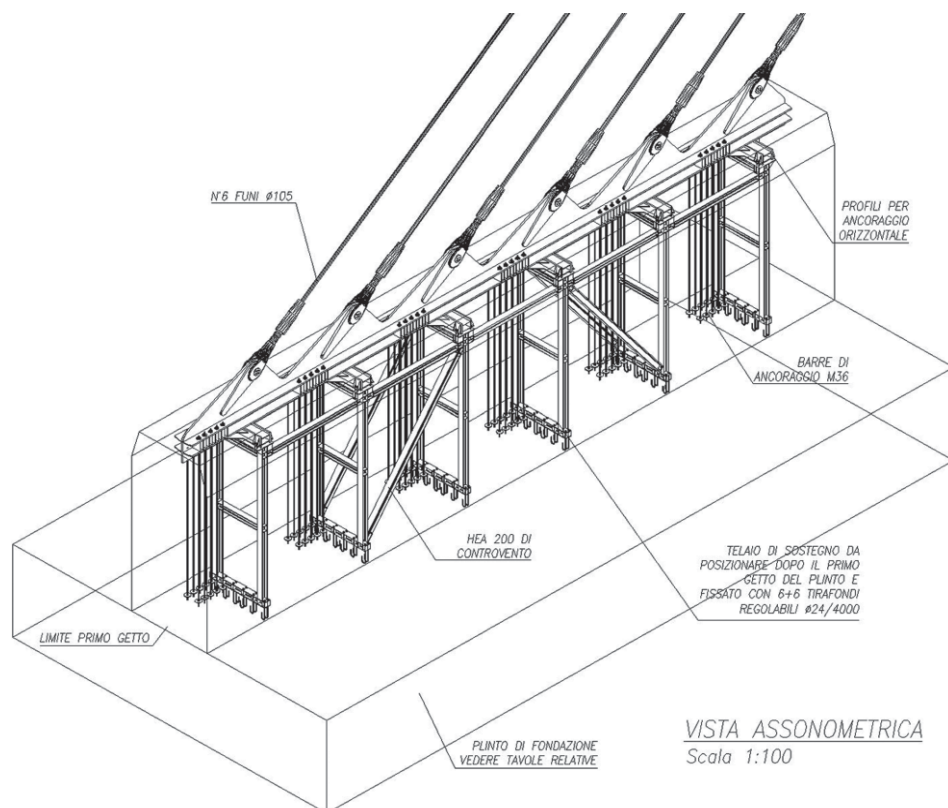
Sistema di posizionamento provvisorio delle piastre di collegamento degli stralli
